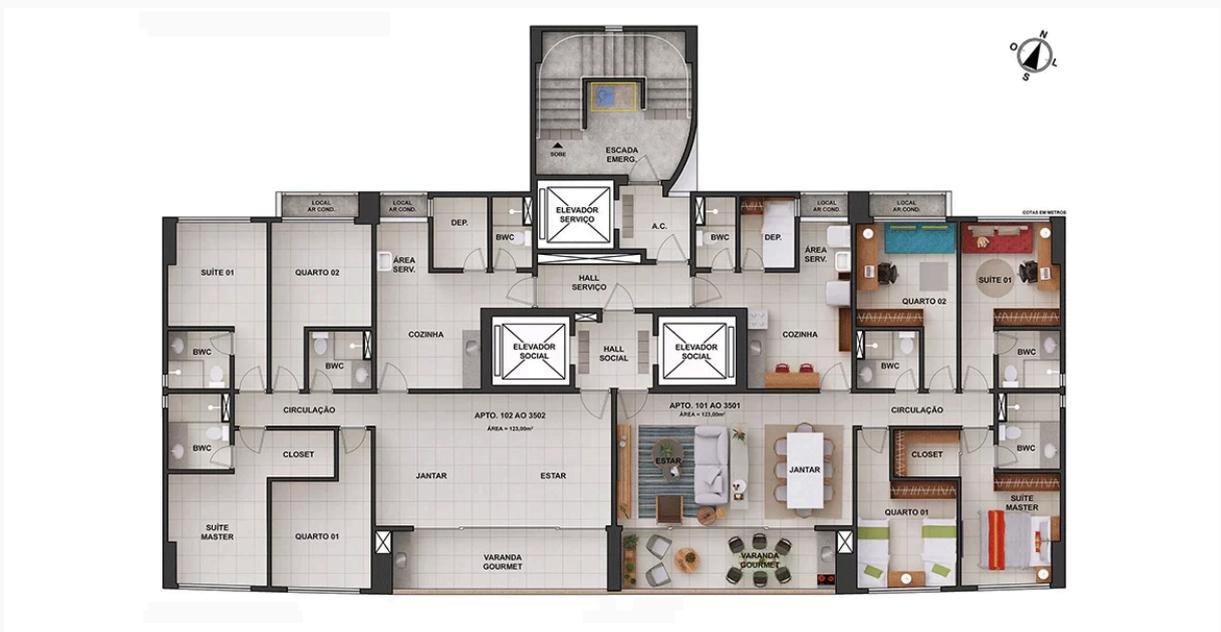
Planta Baixa Humanizada Edifício Zélia Macedo.
